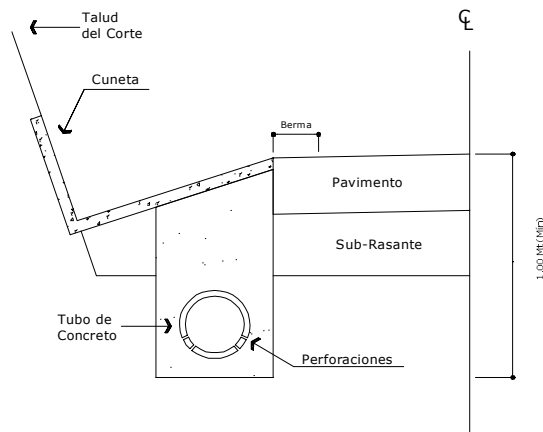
Sección Transversal de un Subdren Longitudinal
